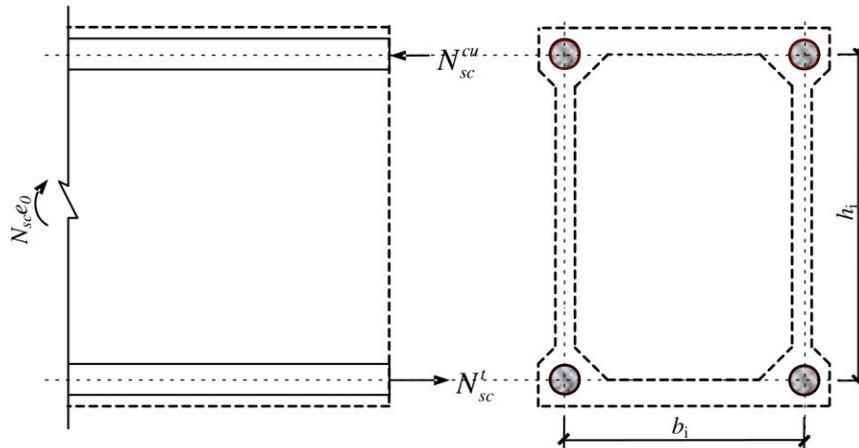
组合截面主拱正截面偏心受压承载力计算简图
